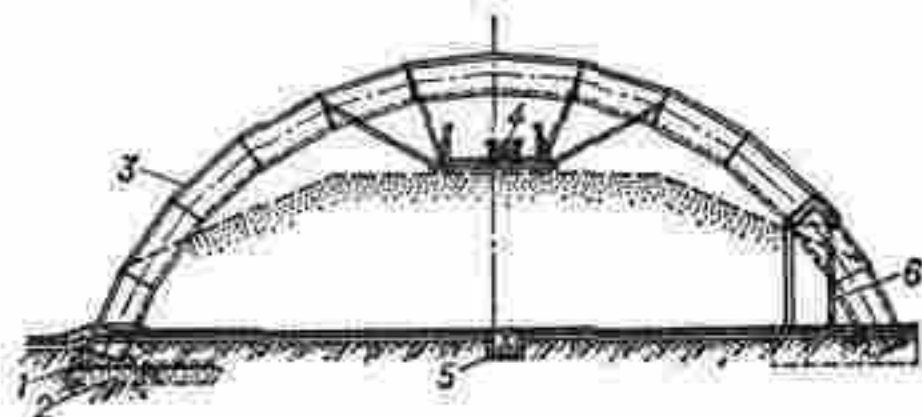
Напольное зернохранилище из сборного железобетона со сводчатой кровлей: 1 — железобетонный фундамент; 2 — песчаная подушка; 3 — ребристая плита; 4 — транспортёр в верхней галерее; 5 — транспортёр в нижней галерее; 6 — ворота (пунктиром отмечена ёмкость, загружаемая зерном).
